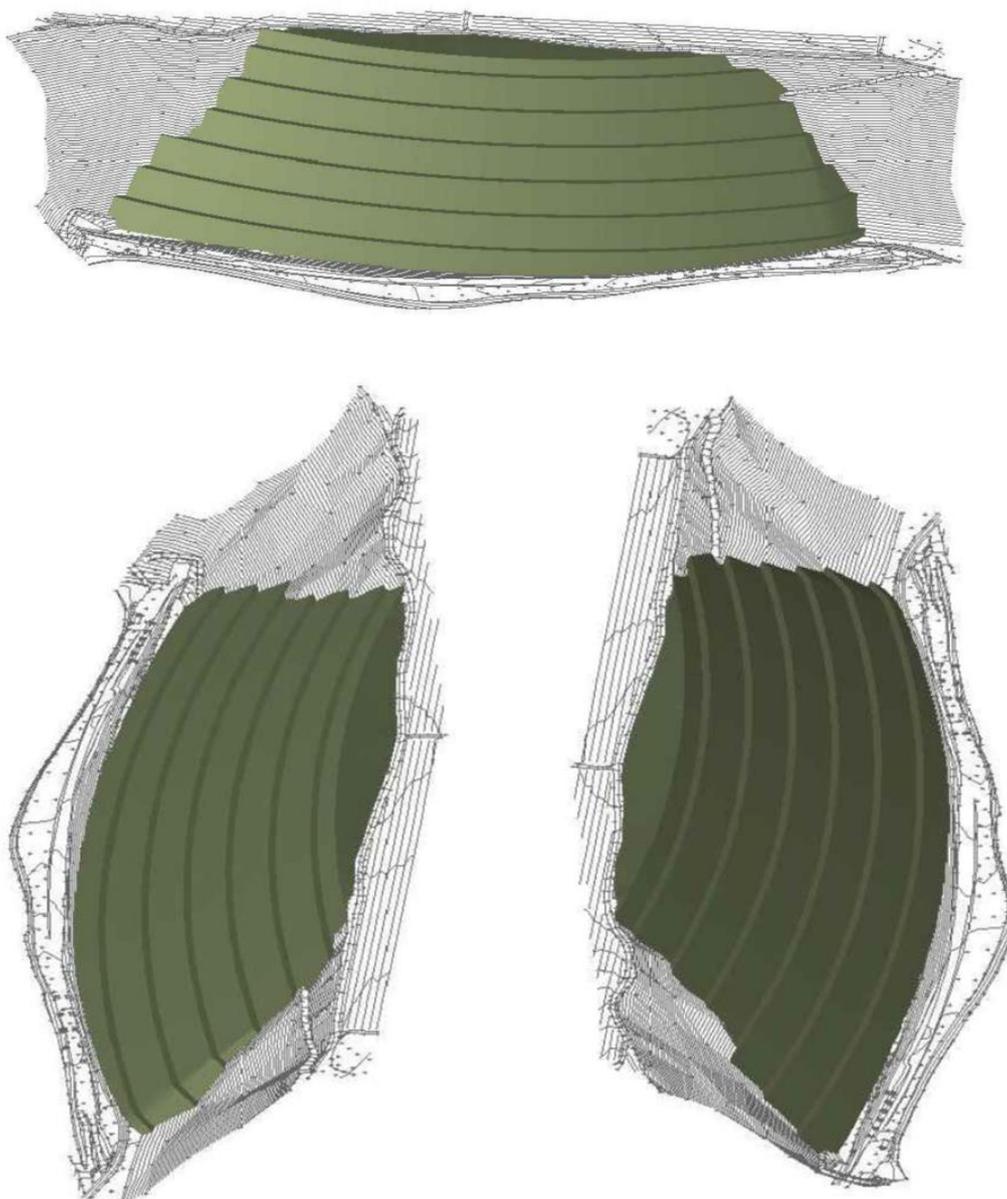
Vista 3D fase finale di progetto del deposito di Plattner
